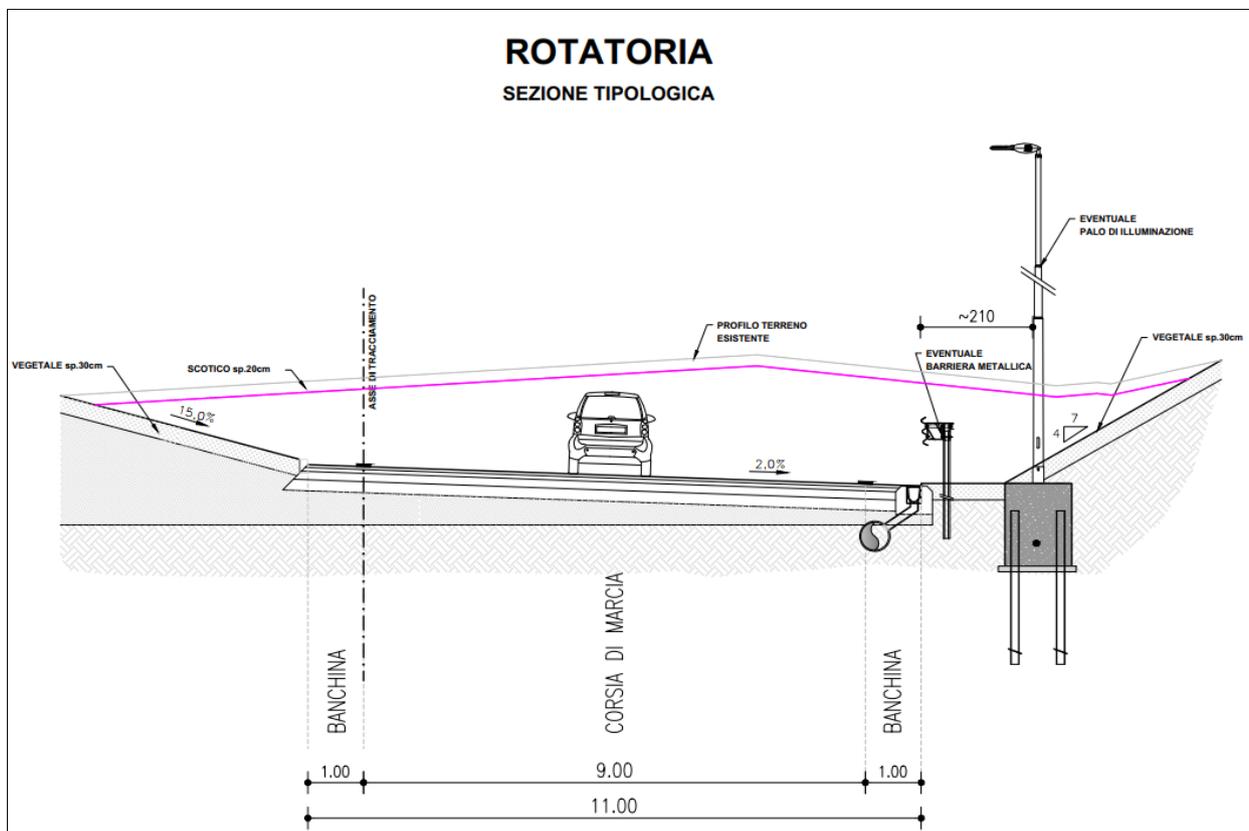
Sezione della rotondella prevista all'intersezione con la via G. Di Vittorio
